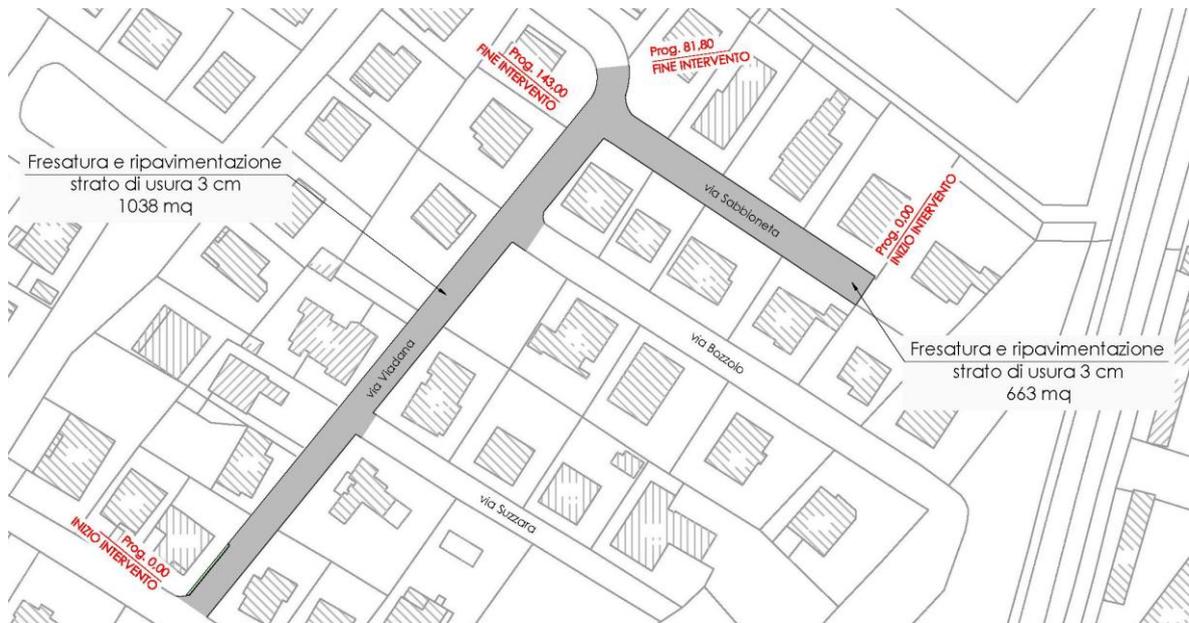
Planimetria di progetto - via Viadana e via Sabbioneta
